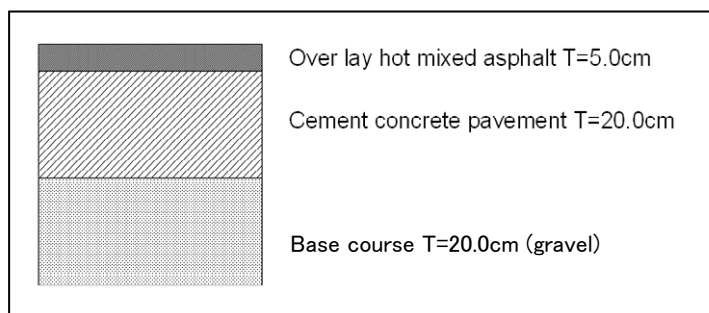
Altura de las Capas de Pavimento de Concreto Existente
